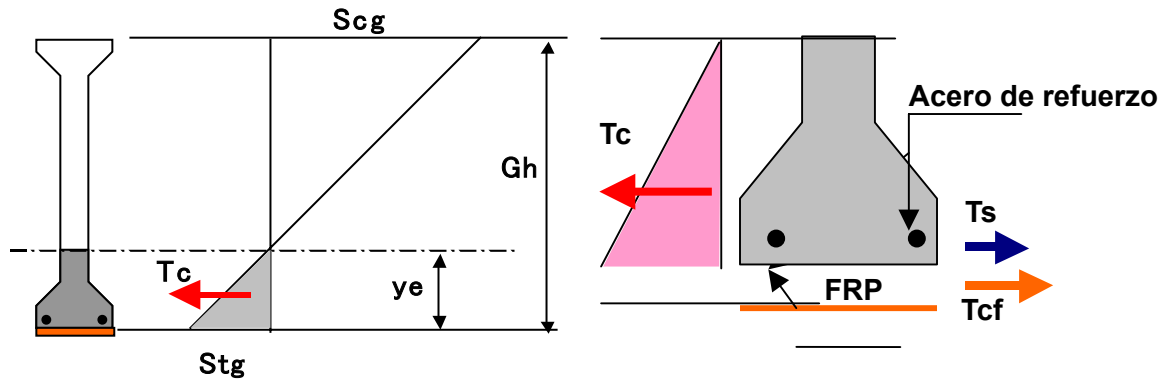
Imagen del esfuerzo de tensión de la viga tipo I prefabricada
